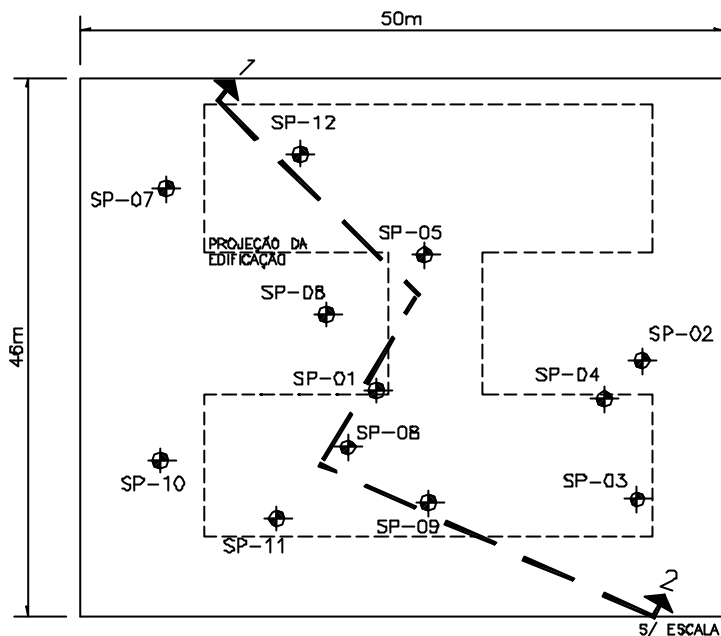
Croqui de Localização das Sondagens à Percussão.
